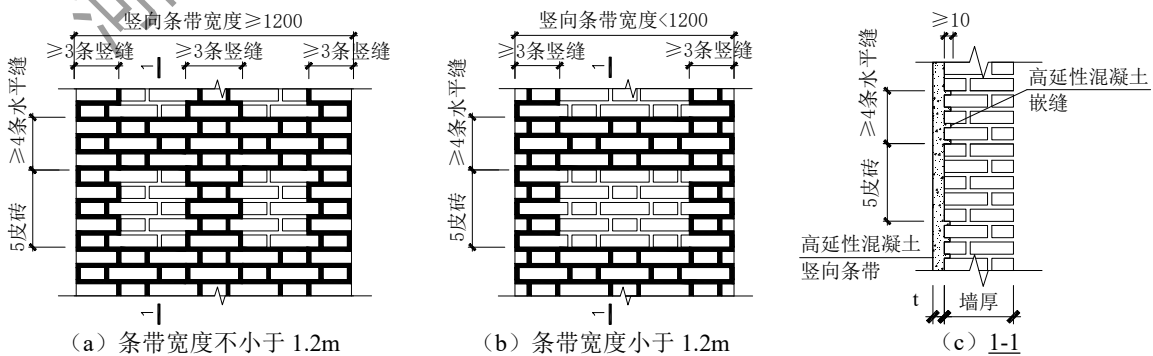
高延性混凝土竖向条带嵌缝示意图
